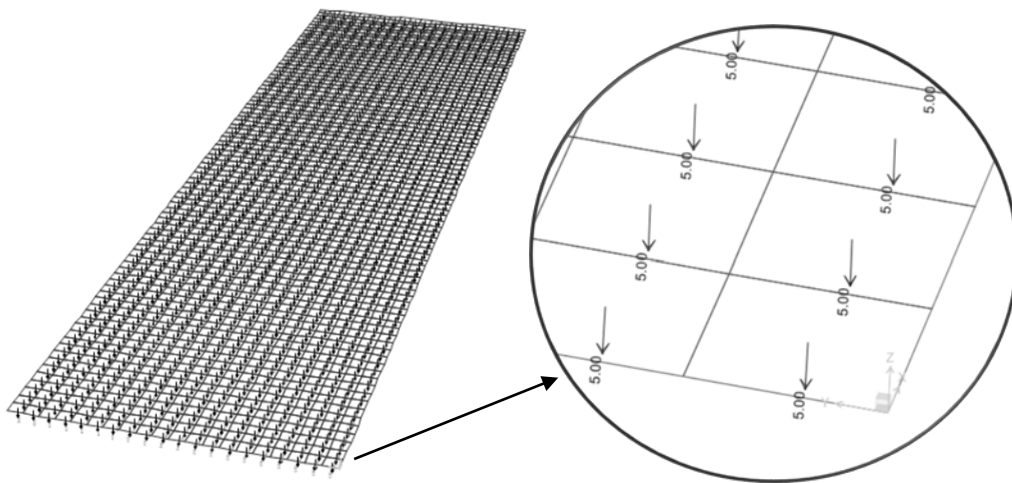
Sobrecarga na Laje de Ensoleiramento
